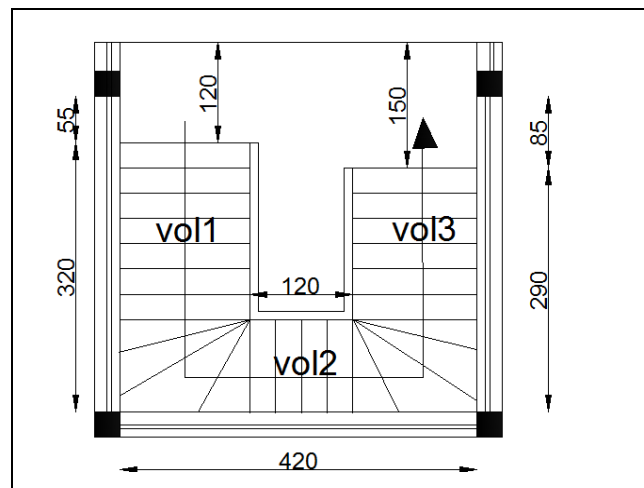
Vue en plan d'escalier typeII (RDC).
